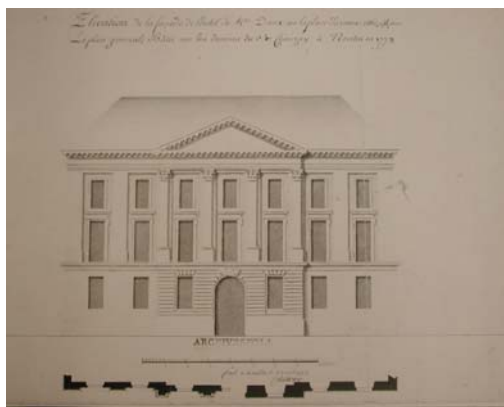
Façade du bâtiment de la place d'armes établi par Ceineray en 1773 et extrait d'un module de façade
